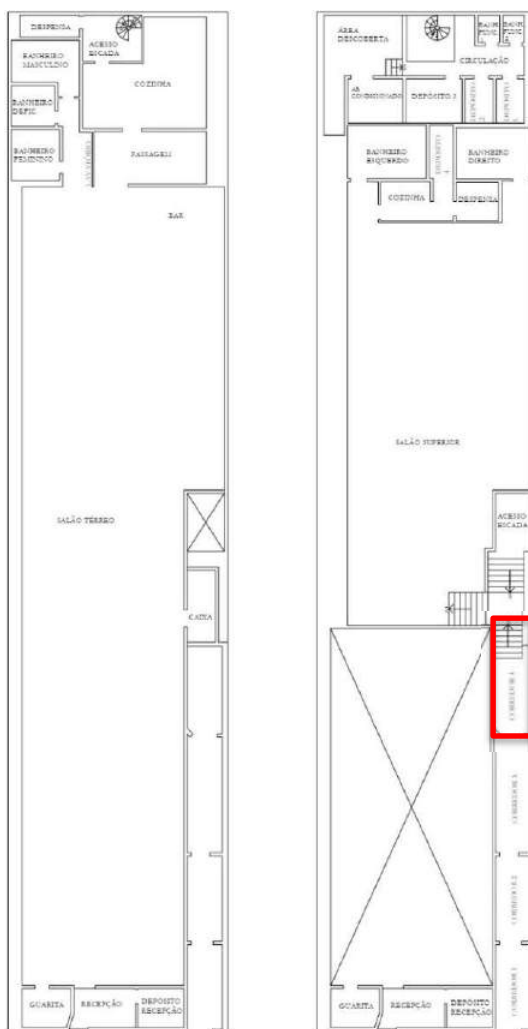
PONTO DE INFILTRAÇÃO NA ESCADA DE ACESSO AO SALÃO SUPERIOR.
